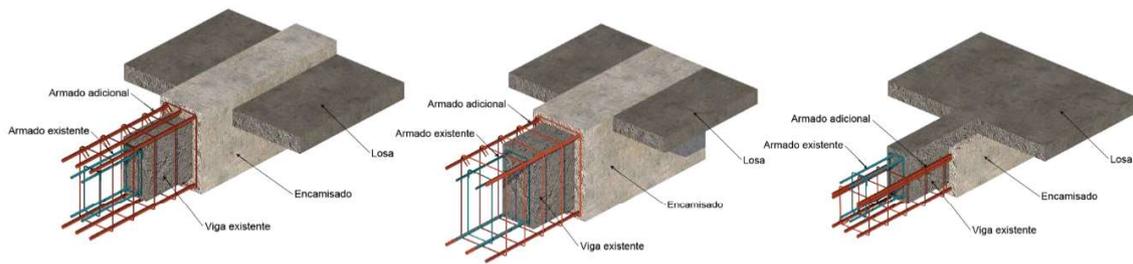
Posibles configuraciones de encamisado de vigas con concreto: a) encamisado sobre nivel superior de losa; b) encamisado al nivel del piso; c) encamisado por debajo de la losa. Fuente: INIFED (2021d) con base en Terán (2009)
